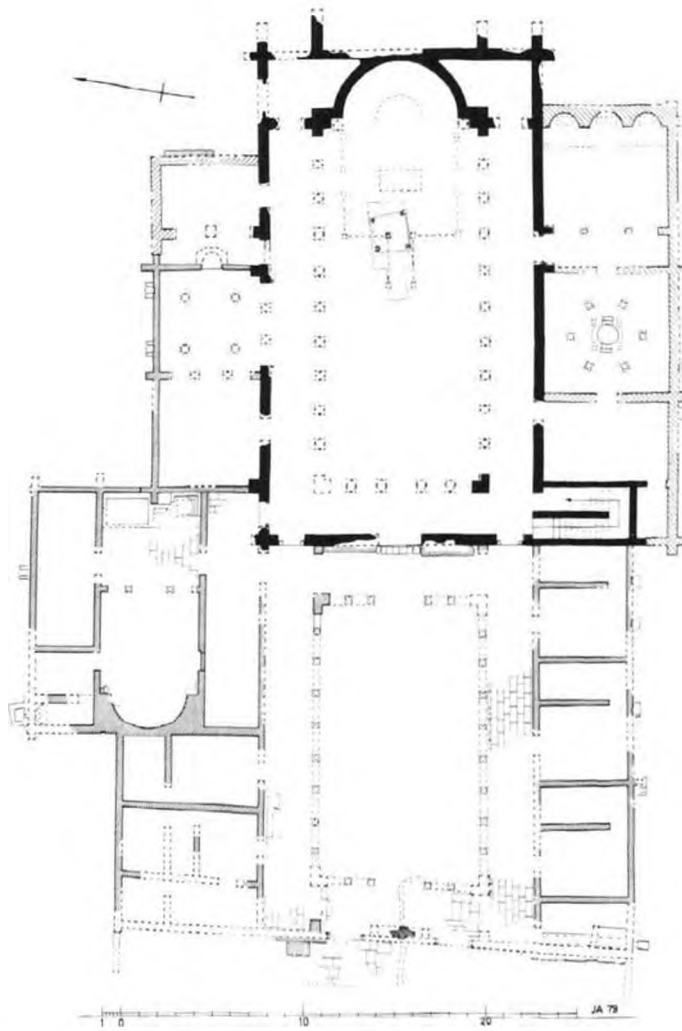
Nordbasilika, Massenplan der Bauaufnahme mit Ergänzungen und Angaben zur Position der Vorgängeranlage 1 : 400.
